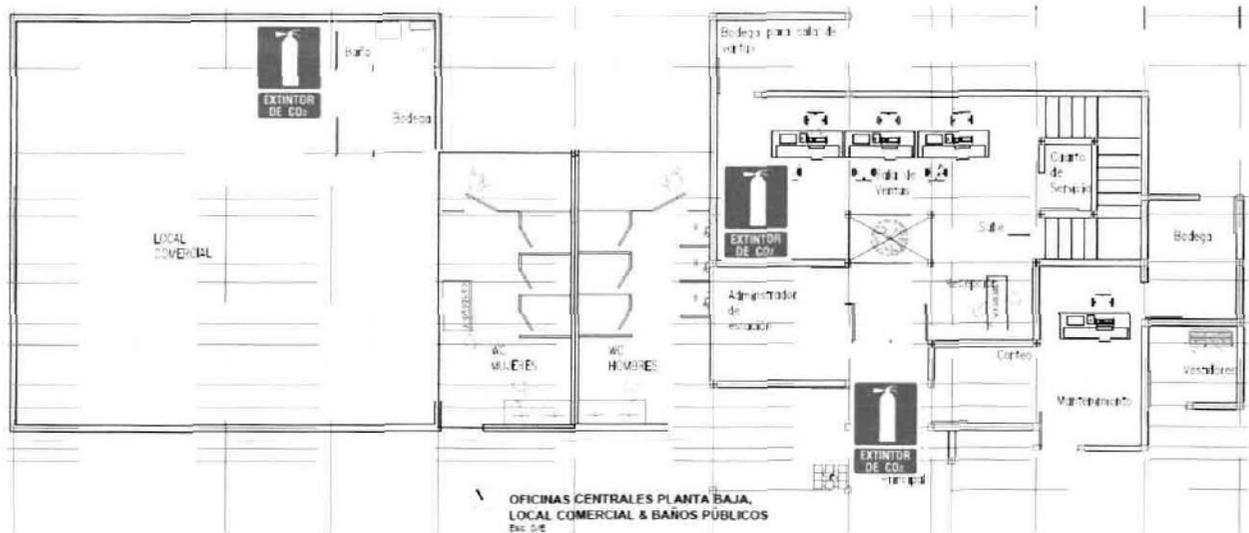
Ubicación de extintores – Oficinas Planta Baja
